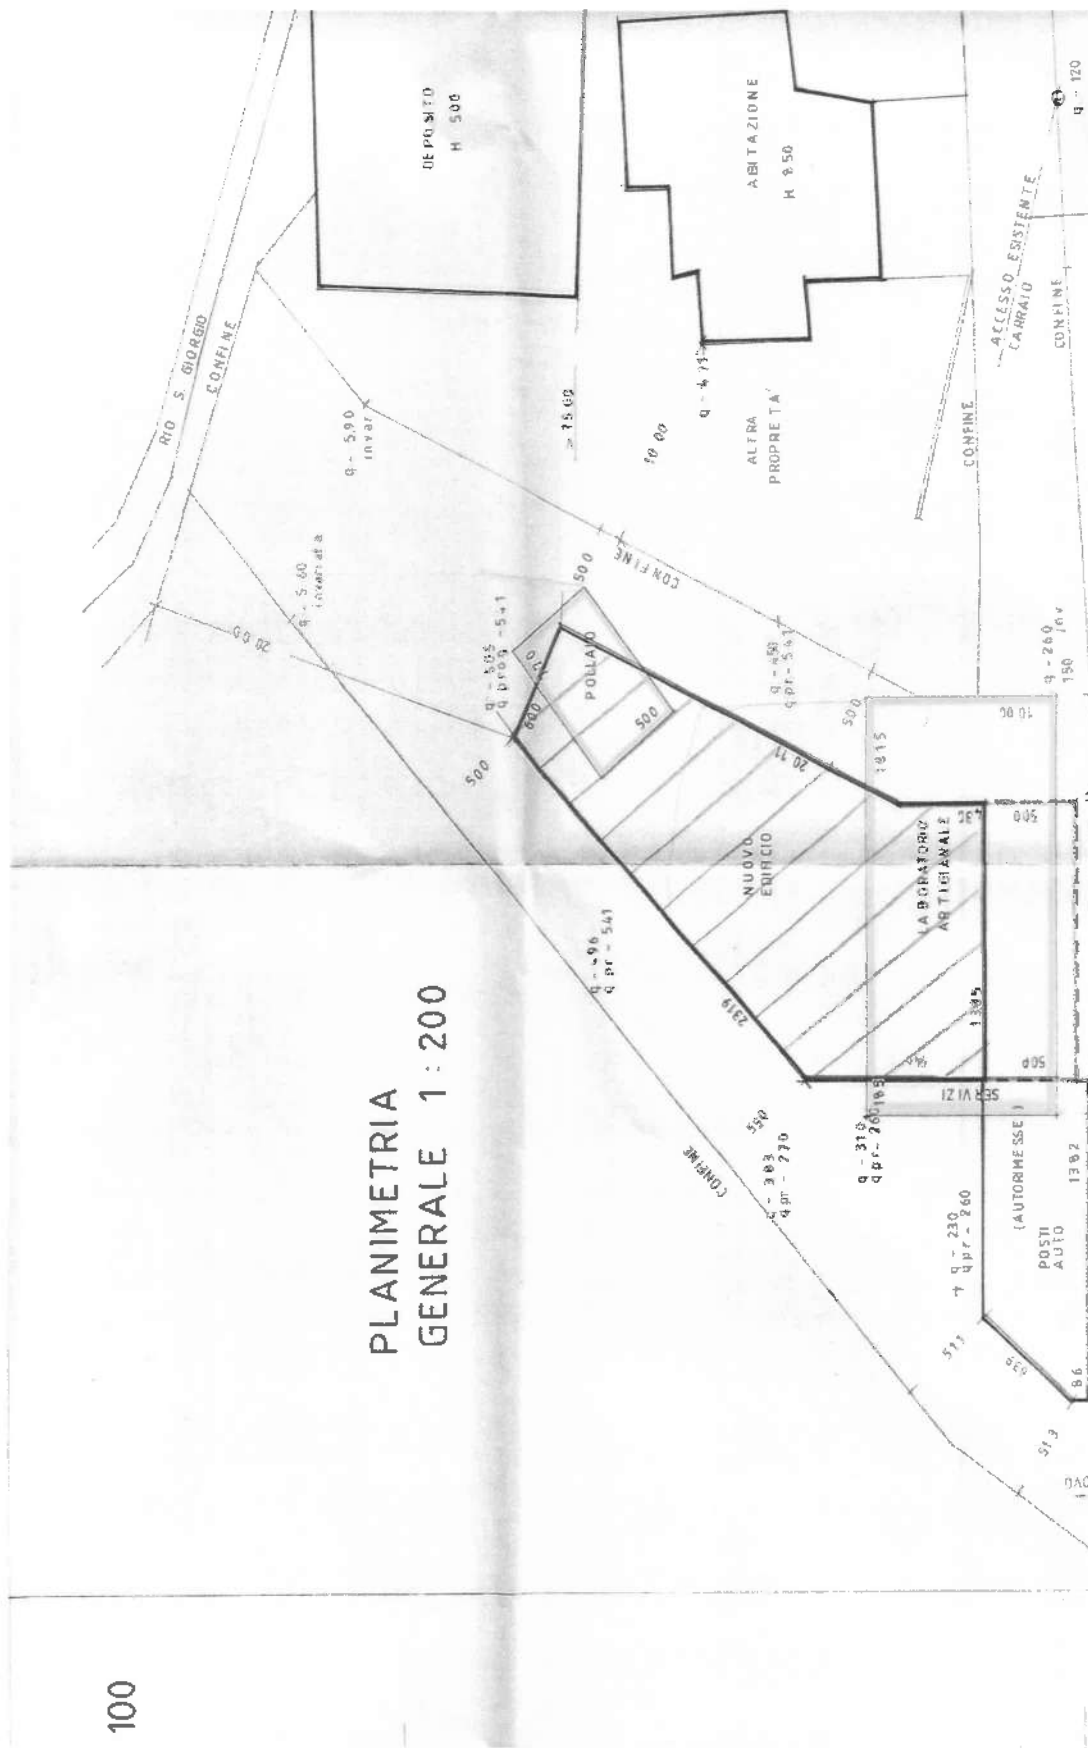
Pianta 3 – Planimetria intervento previsto allegato alla richiesta P.C. 50/07.
